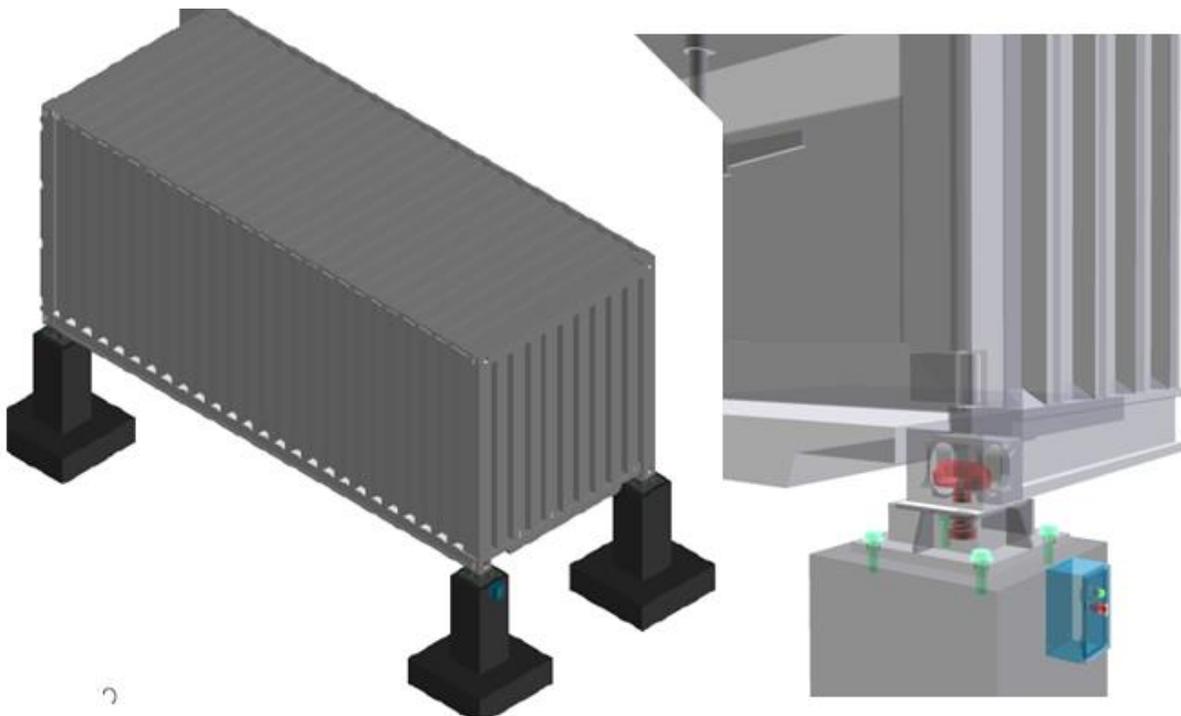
Detalle de modelo de anclaje del contenedor a la cimentación. Elaboración propia. 2021.
